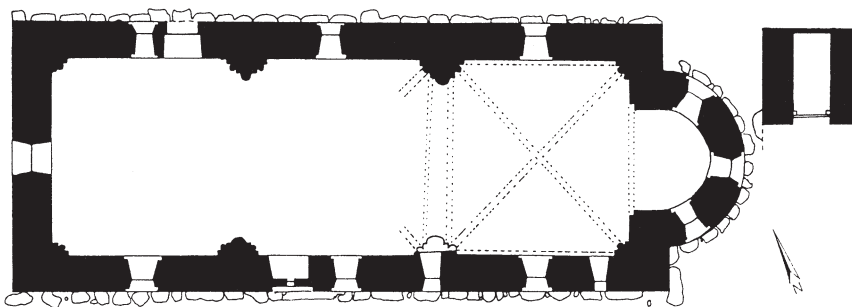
Blersum. Grundriss der Kirche von Blersum mit Findlingsfundament. (Grundriss nach NOAH 1969, Tafel 43). M. 1:250. (Zeichnung: G. Kronsweide)
